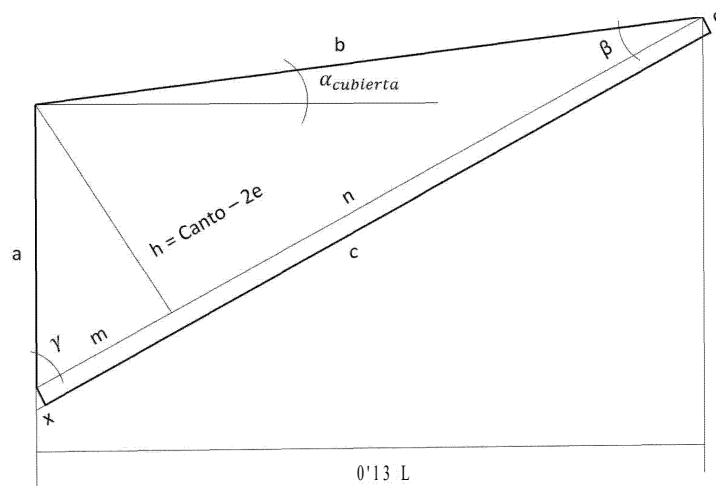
Esquema de la geometría de la cartela del pórtico
